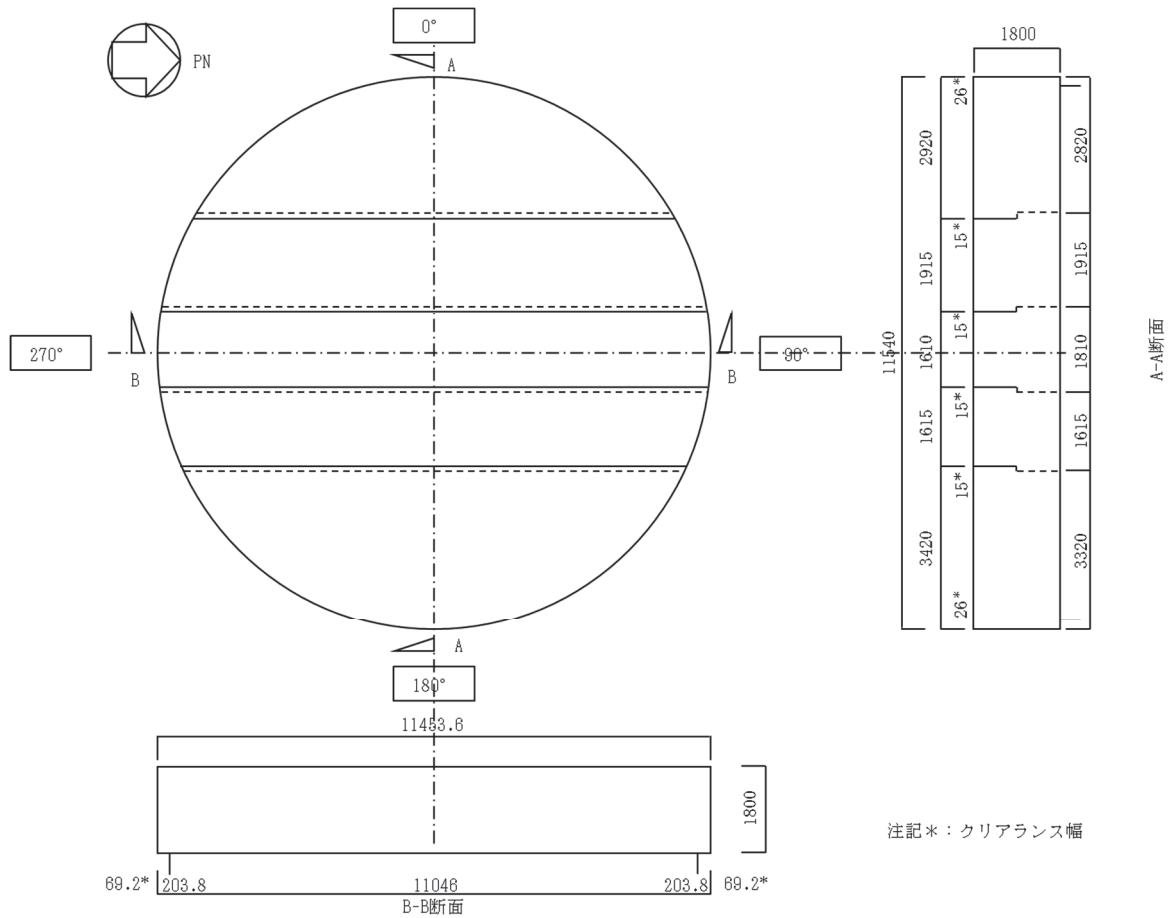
原子炉ウェルカバー概要図(単位 : mm)
